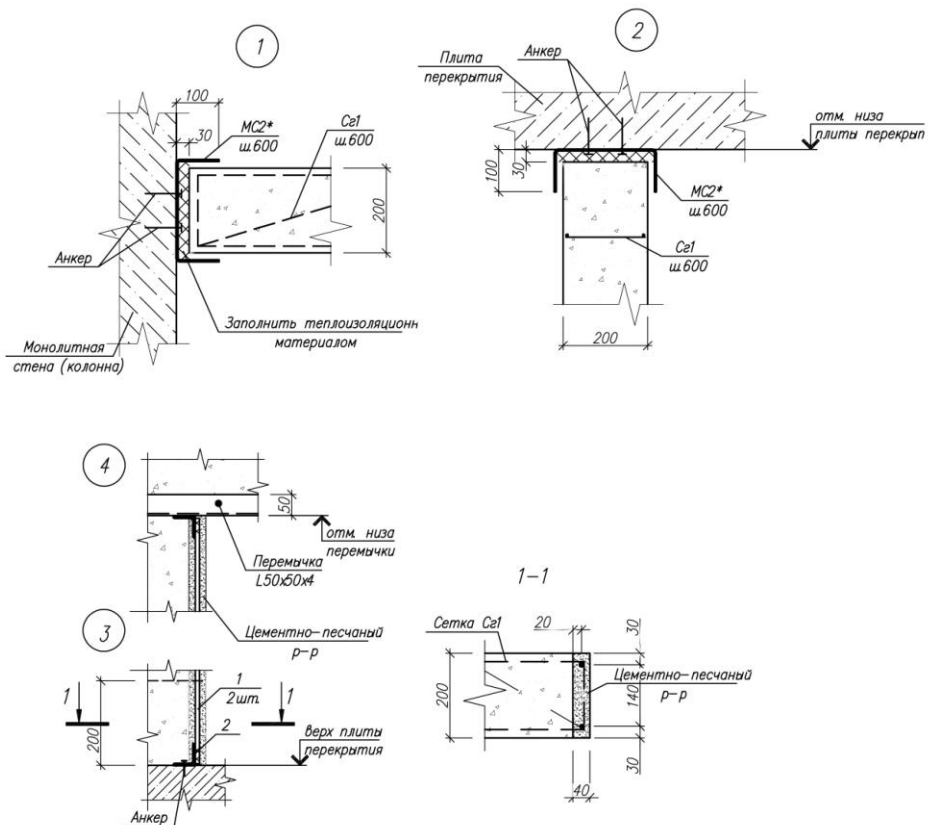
Узлы крепления наружных стен из керамзитонных блоков
